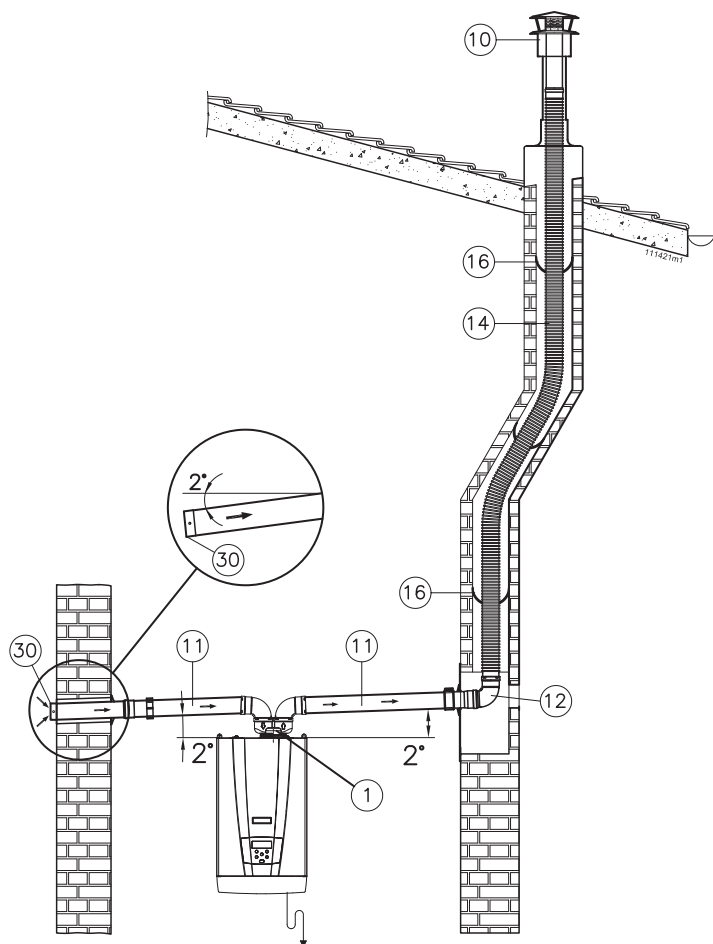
Esempio di installazione "Sistema 80/80 PP"
